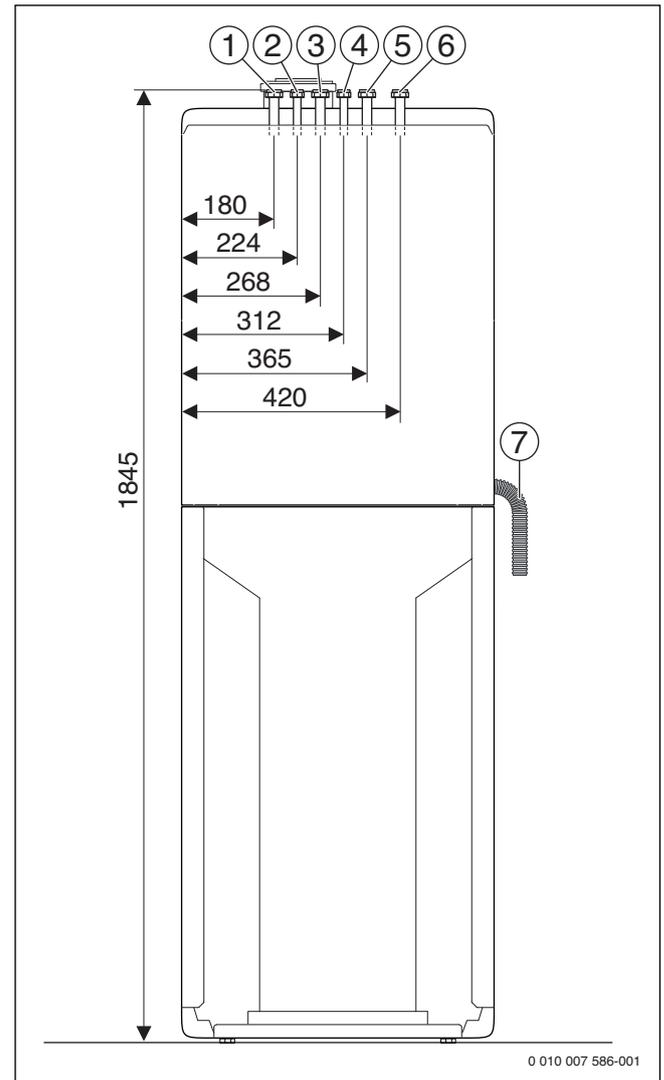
Anschlussmaße des Zubehörs AS-V1/Vertikales Anschluss-Set (Maße in mm)
